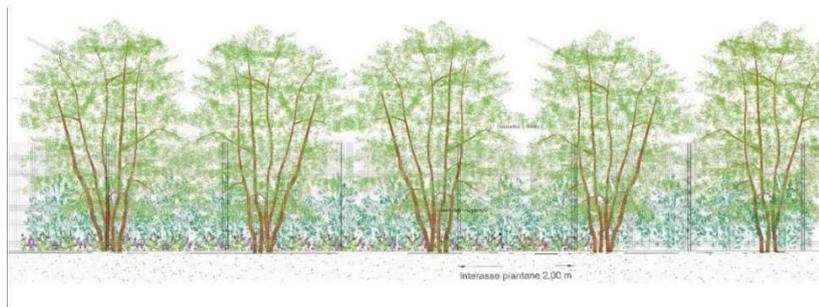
Prospetto recinzione perimetrale con mitigazione
